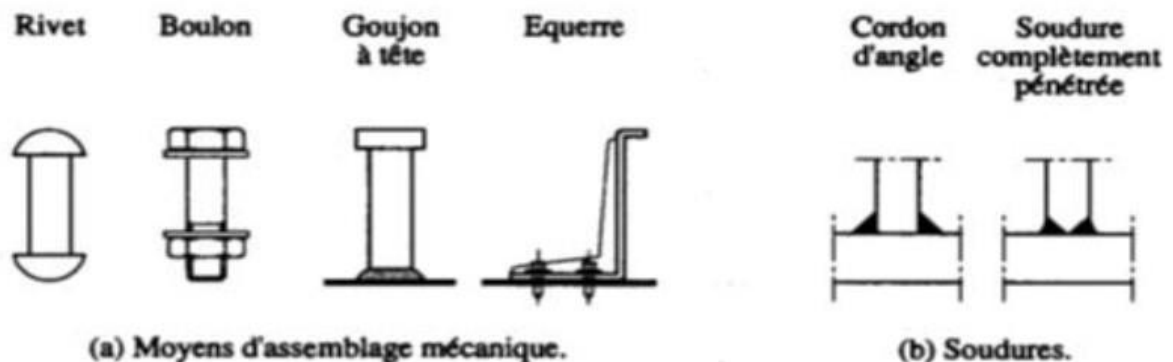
Moyens d'assemblage mécanique et soudures.
